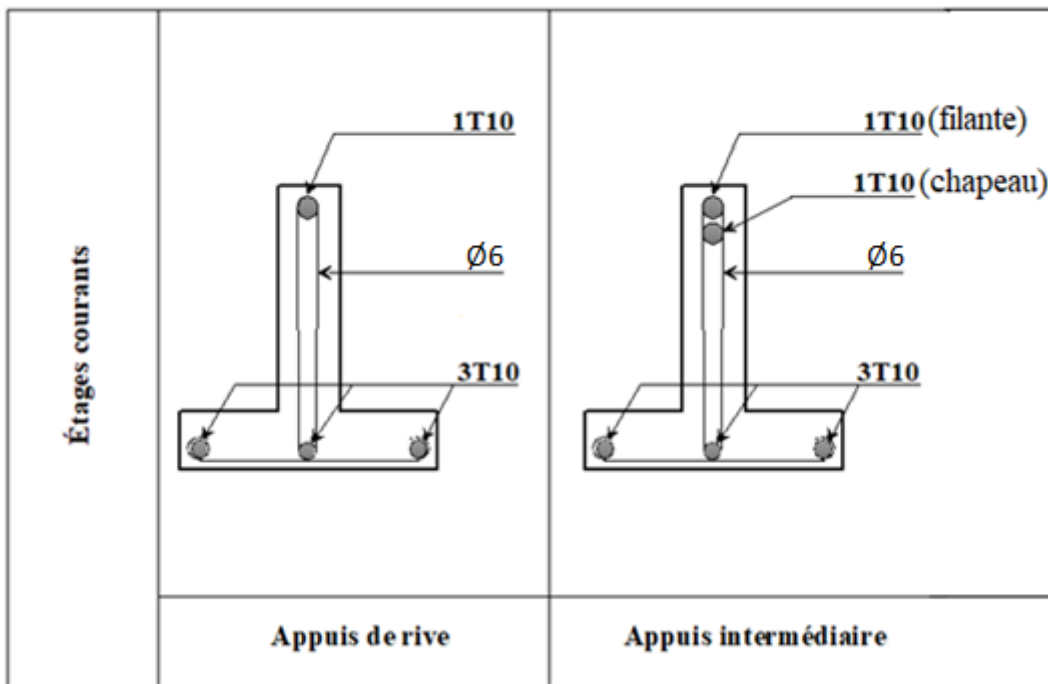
Dessin de ferrailage des poutrelles des étages courants
